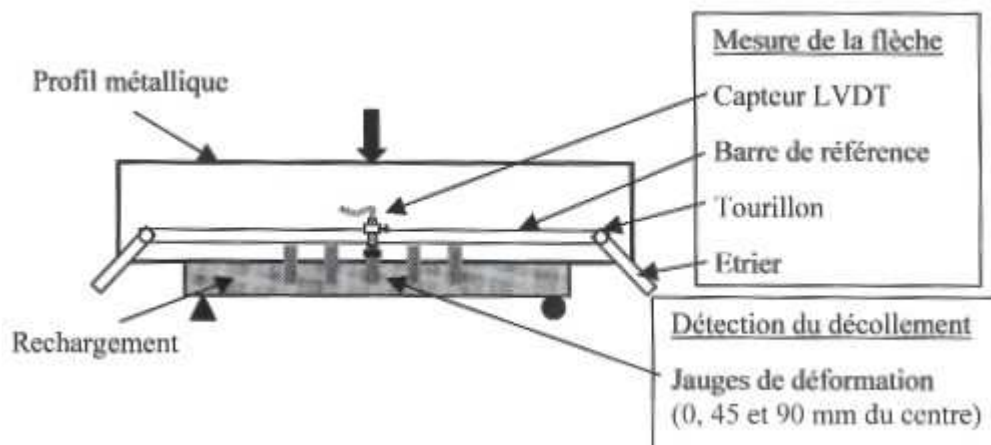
essai d'adhérence en flexion 3 points [Chausson 97]
